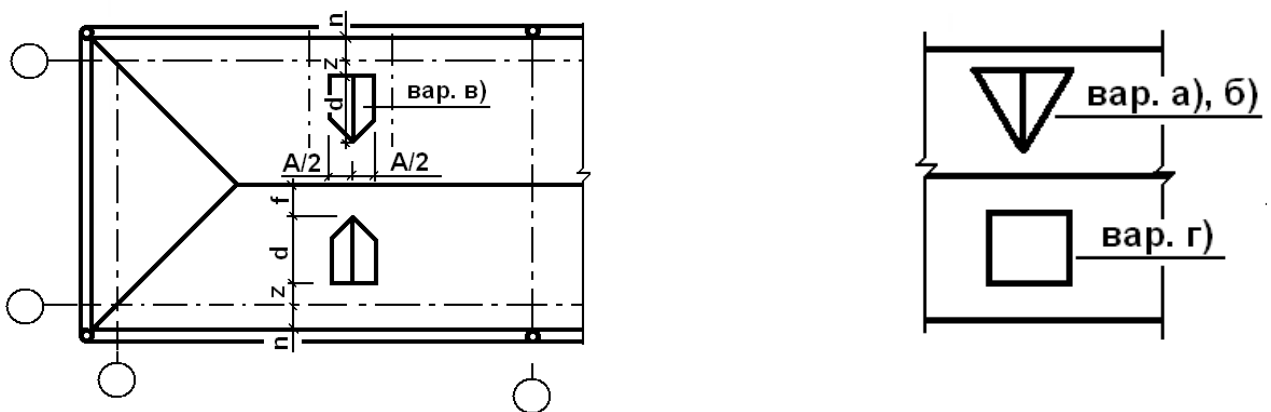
Варианты устройства слуховых окон на плане кровли
